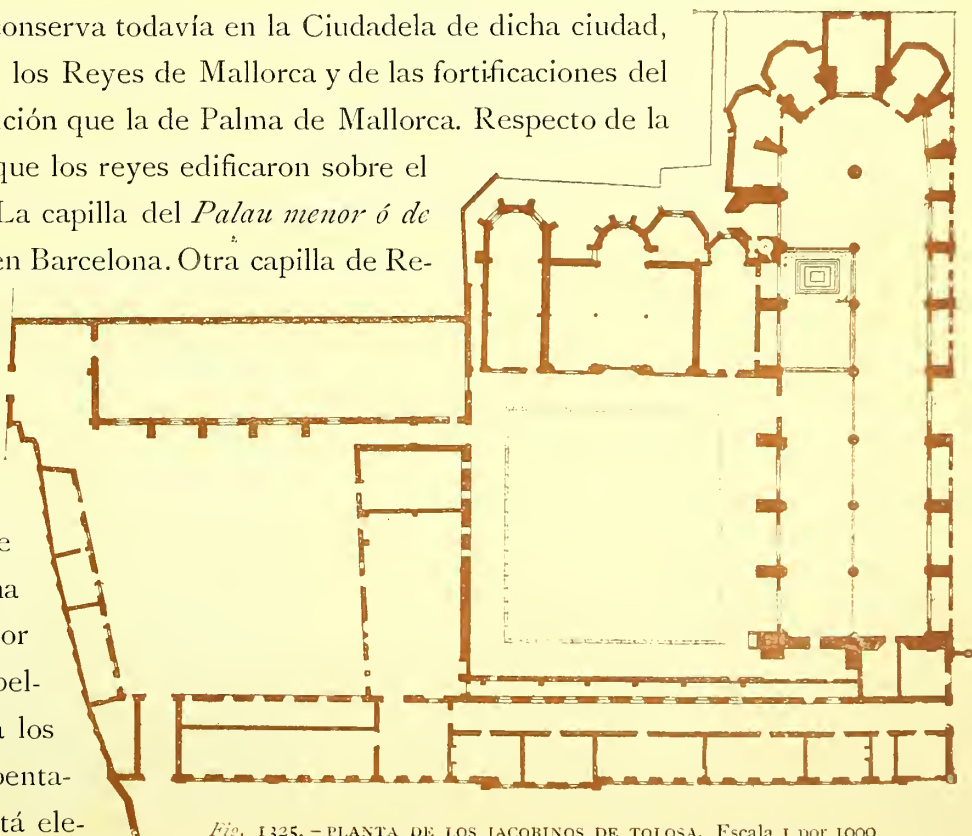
PLANTA DE LOS JACOBINOS DE TOLOSA. Escala 1 por 1000
